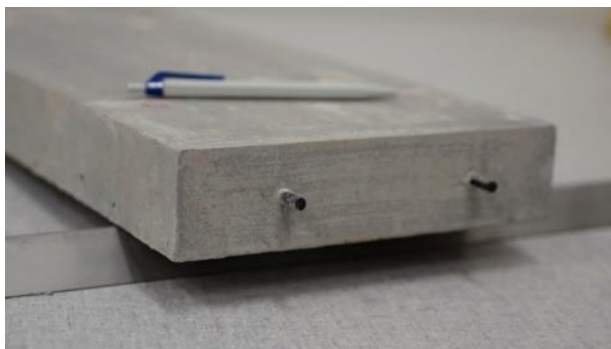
Viga de hormigón con plástico reforzado con fibra de carbono (PRFC) como refuerzo. (Wyrzykowski, Terrasi, & Pietro , 2020)
